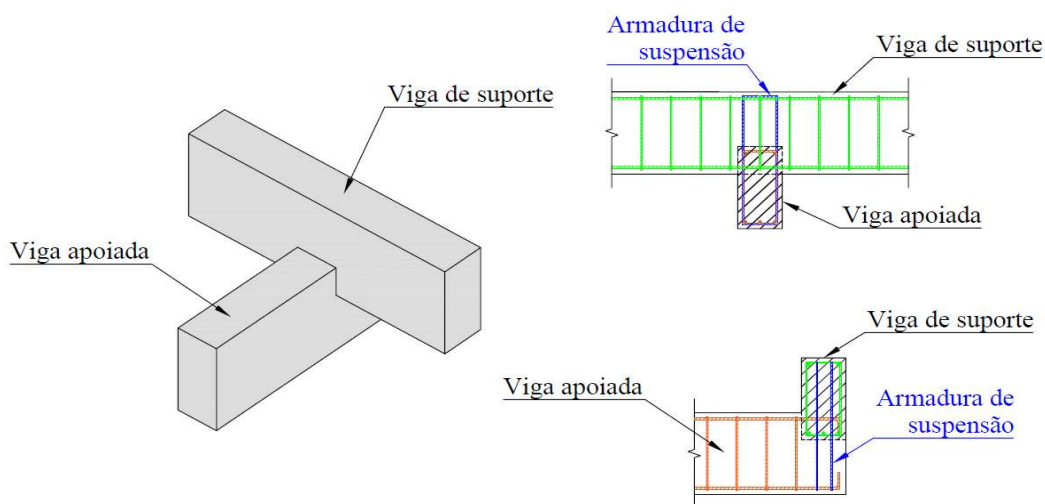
Distribuição da armadura de suspensão para vigas penduradas
